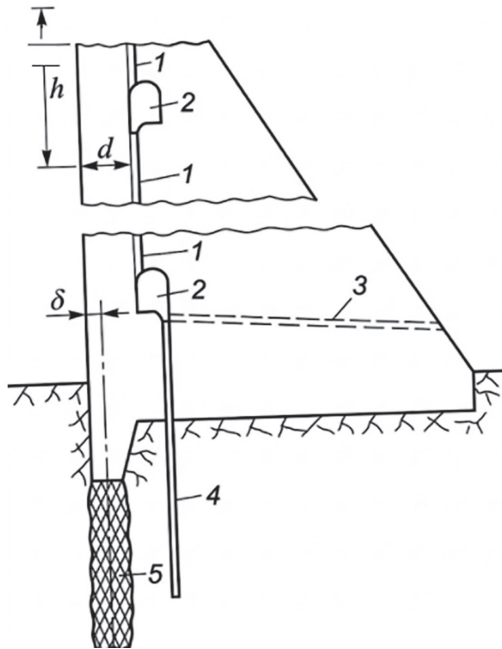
Presa de hormigón con cortina y drenaje vertical.
